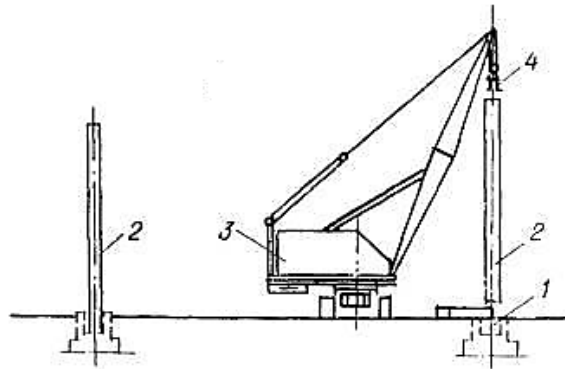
Схема монтажу колони в фундамент старанного типу: 1 – стакан фундаменту; 2 – колона; 3 – кран; 4 – траверса, <https://studfile.net/preview/4179863/>
